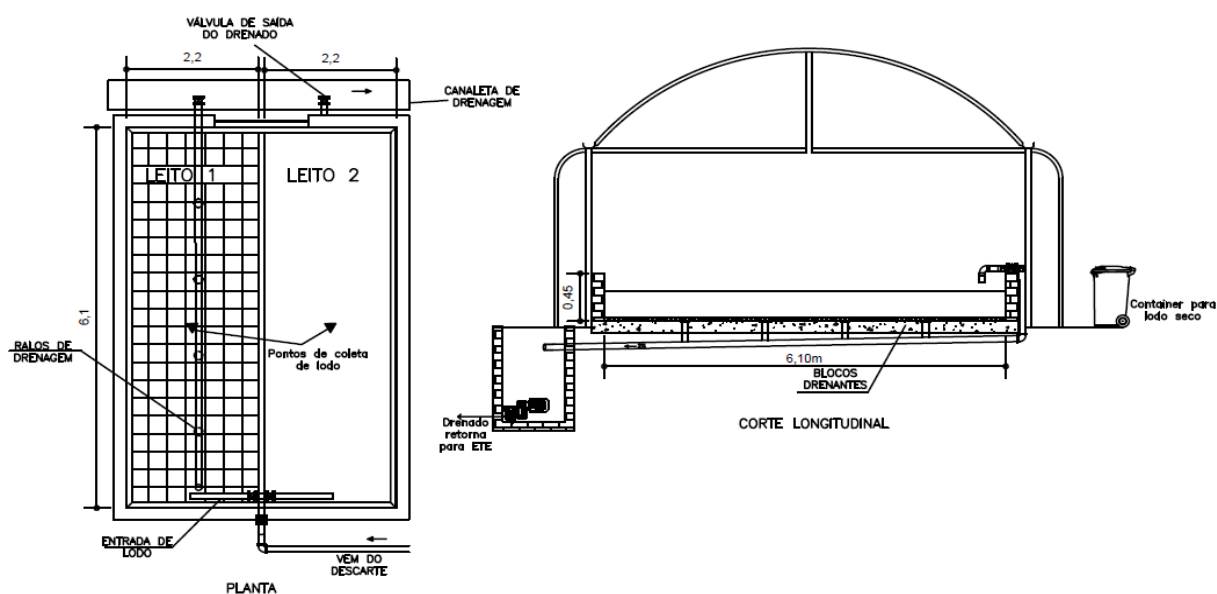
Planta e Corte longitudinal do leito de secagem da ETE.
